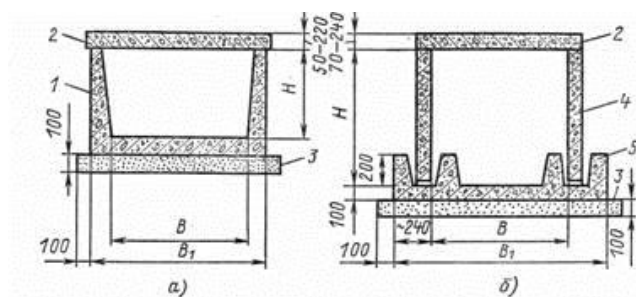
Сборные железобетонные каналы: *а* – лотковые типа ЛК; *б* – из сборных плит типа СК; 1 – лоток; 2 – плита перекрытия; 3 – подготовка песчаная; 4 – плита; 5 – основание.
